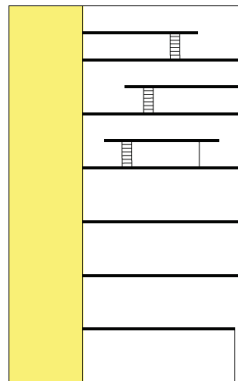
, 66: Grundriss, Schnitt, M ca. 1 : 1.000
